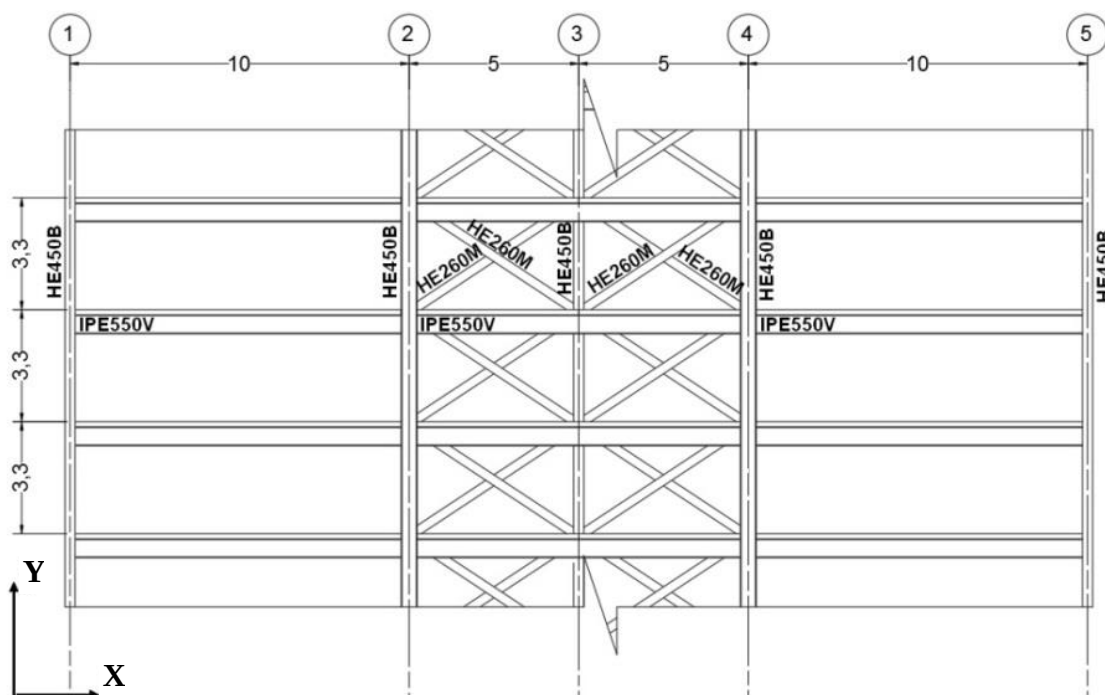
Vista lateral (plano YX) do edifício com núcleo contraventado (contraventamento tipo “XX”) [cotas em metros] (Aguiar, 2014)
